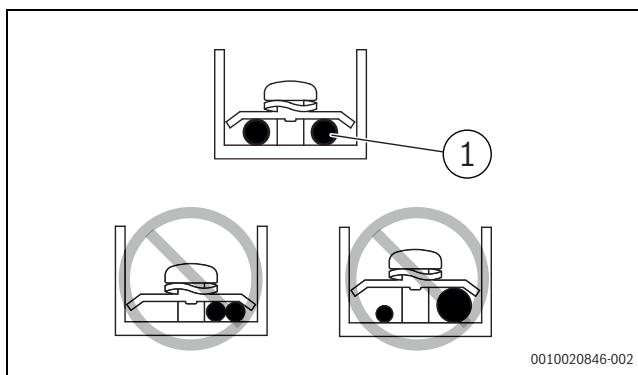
Collegamenti di cablaggio di alimentazione propri e impropri
